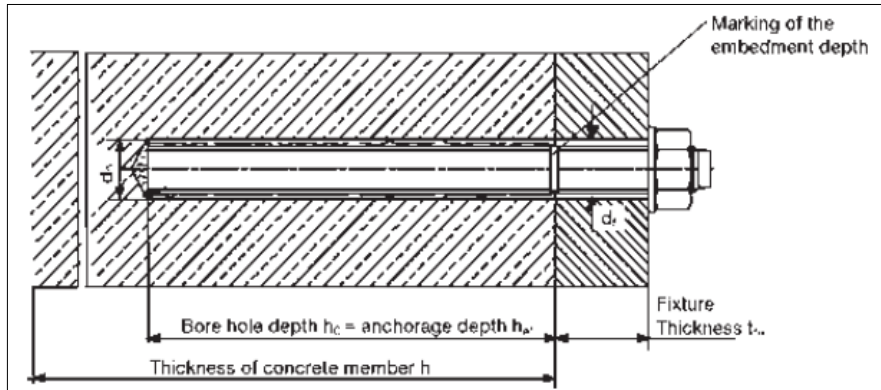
Pormenor de Ligação da Base do Pilar das Escadas Exteriores do Antigo Edifício-BBC, Belém, Bar Café.
